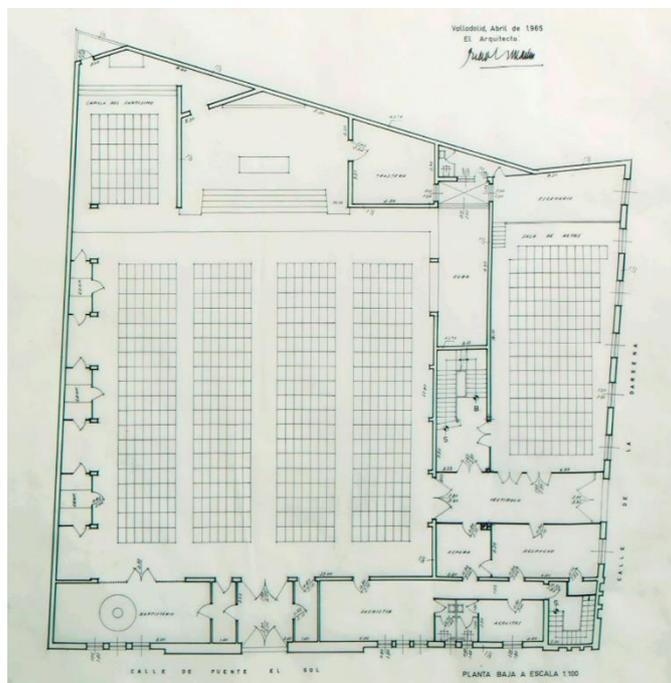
Planta baja de la Parroquia de la Victoria. Fuente: Fragmento de plano del proyecto original de Julio González, 1965, vía <https://jgonzalez.archivosarquitectos.com>
